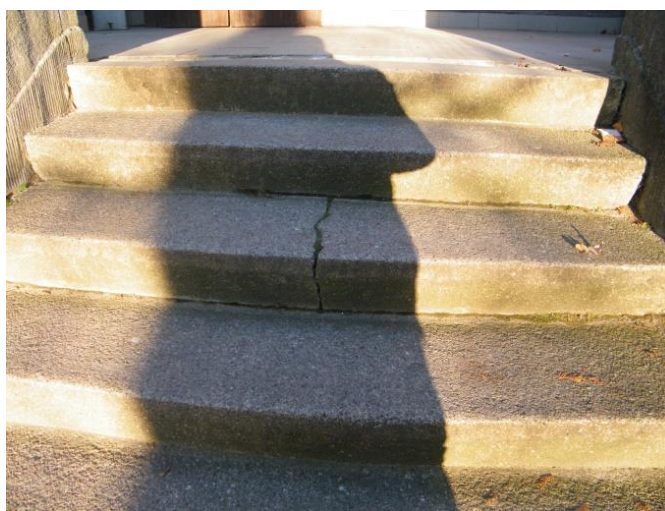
Elewacja szczytowa pld –wsch – wejście do węzła c
